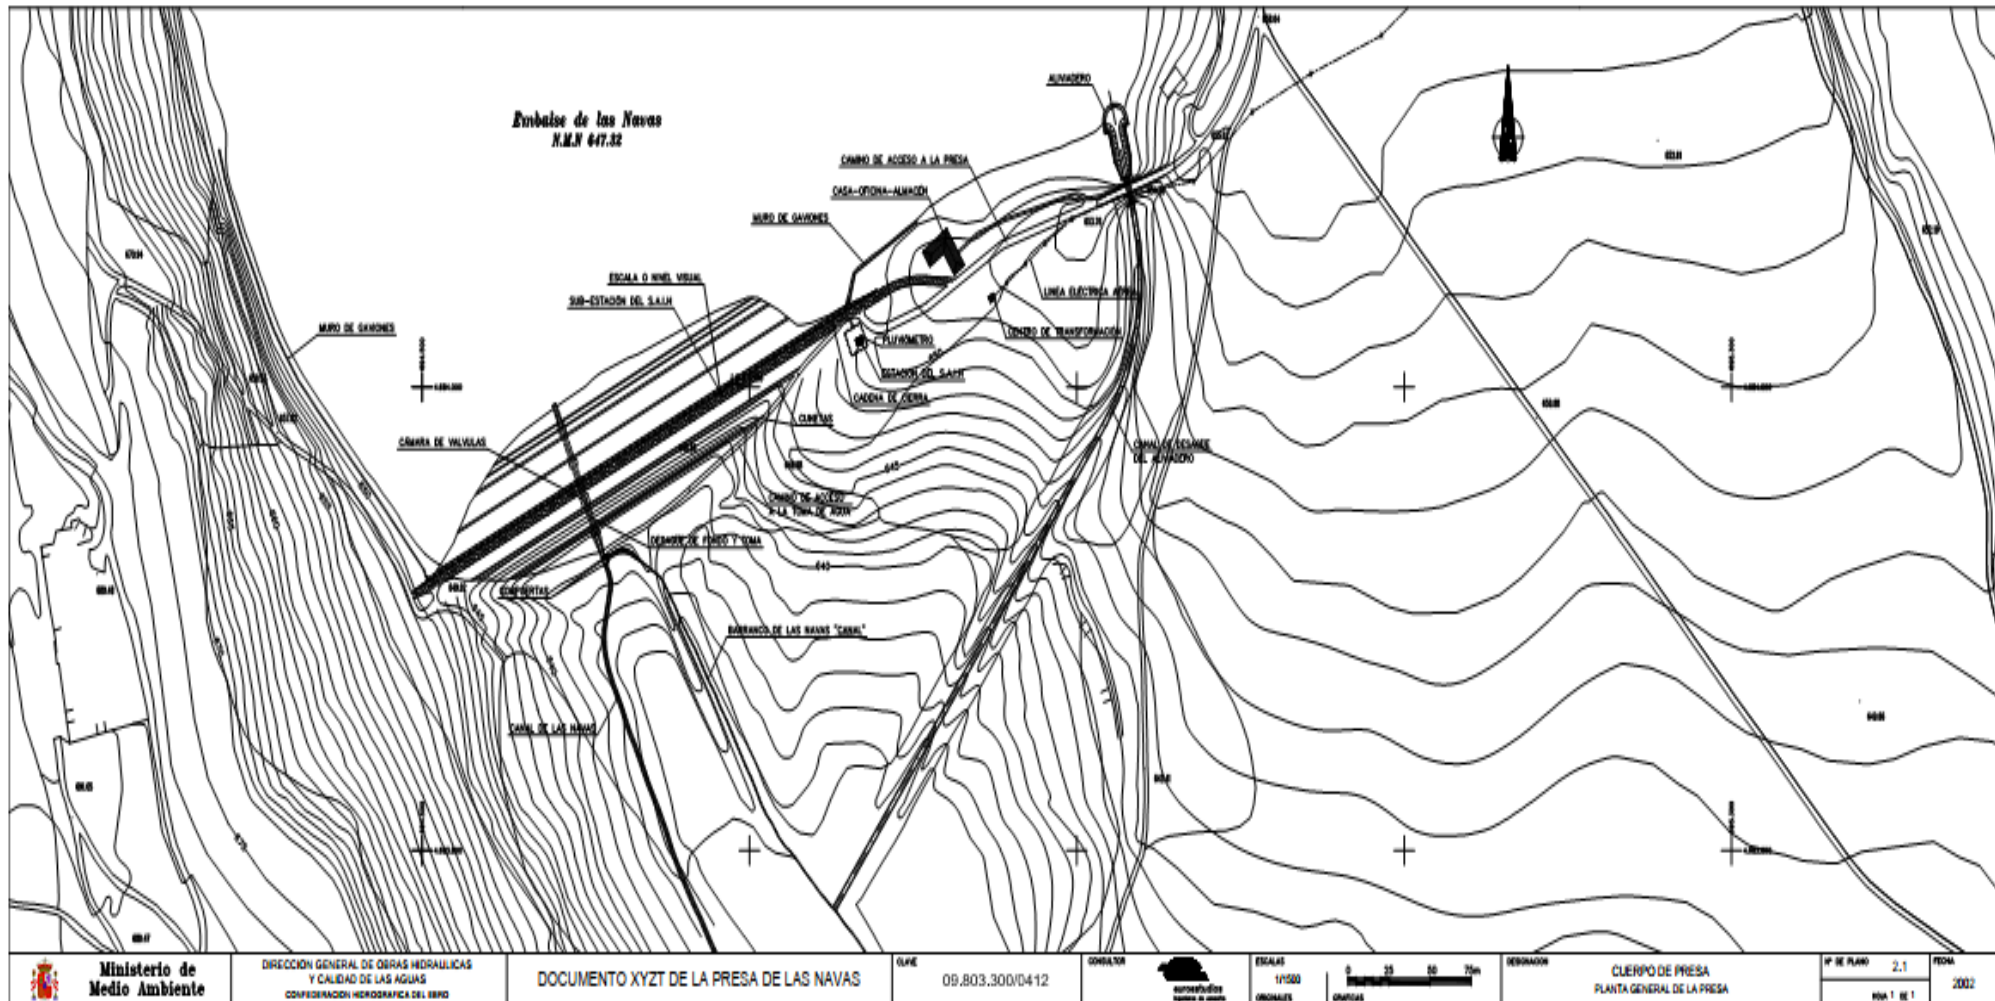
Plano 2.1. Planta general de la presa. Fuente: documento XYZT de la presa de Las Navas (2003).
